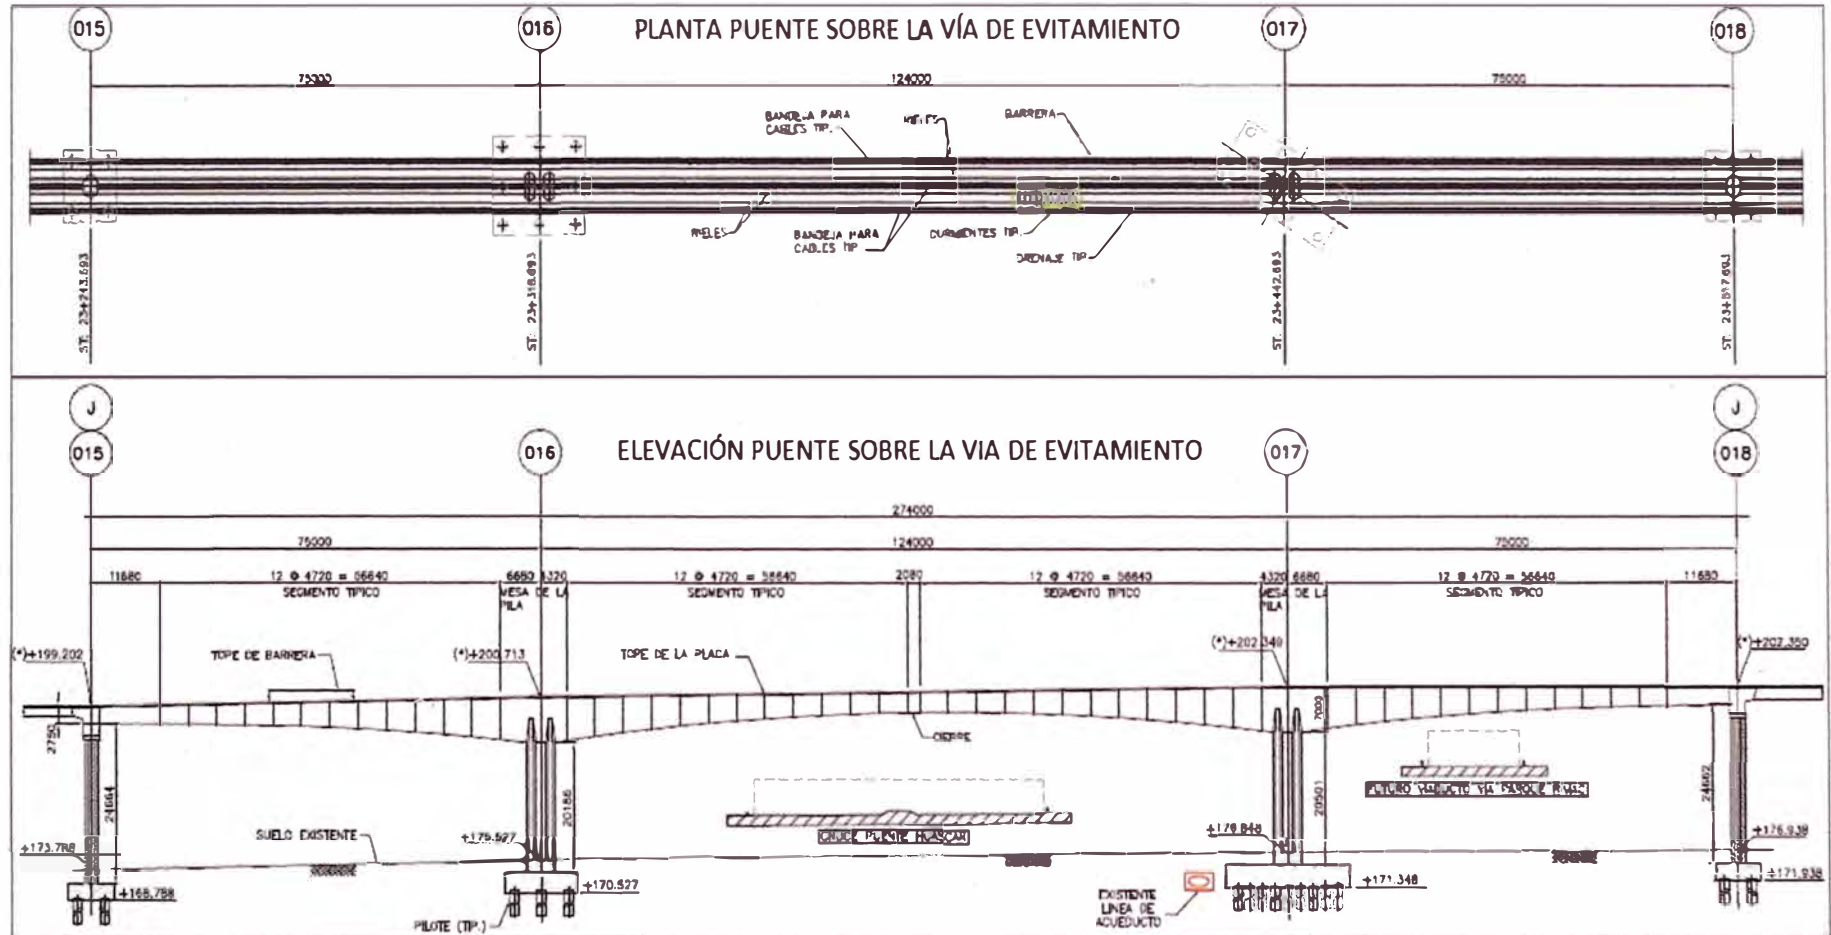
Planta y Elevación del Puente sobre la Vía Evitamiento.
